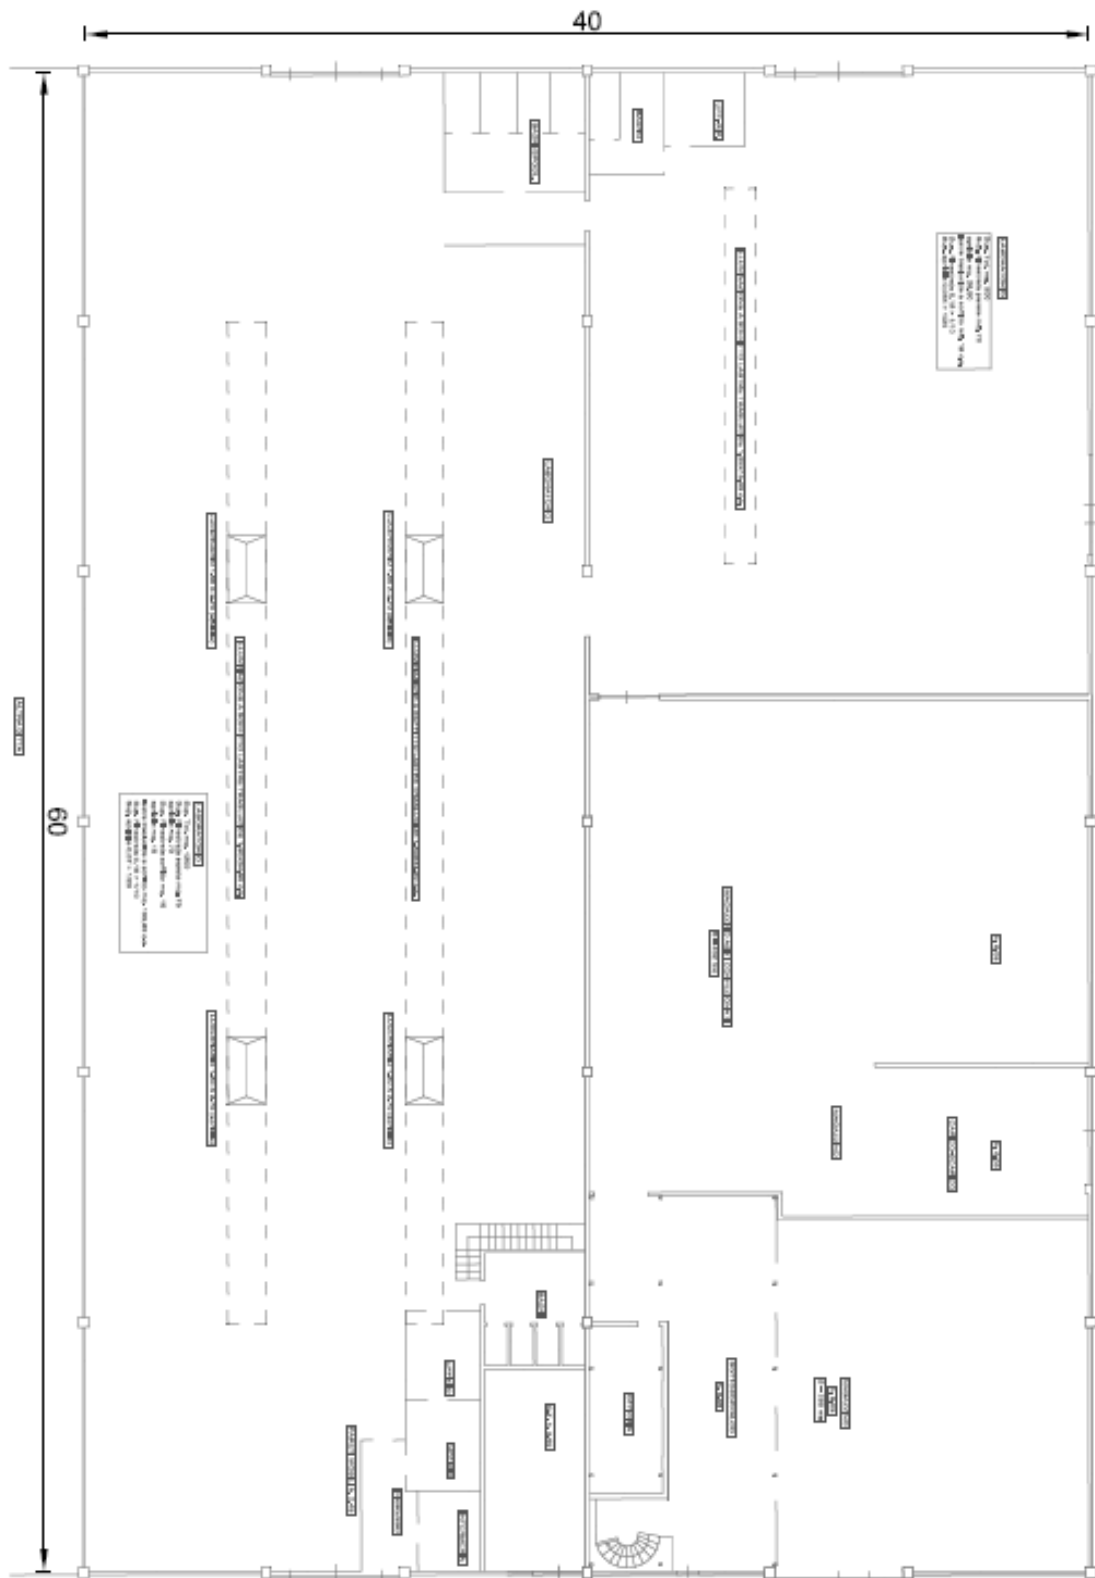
Pianta dello stabilimento produttivo dell'azienda Tesina SRL.
